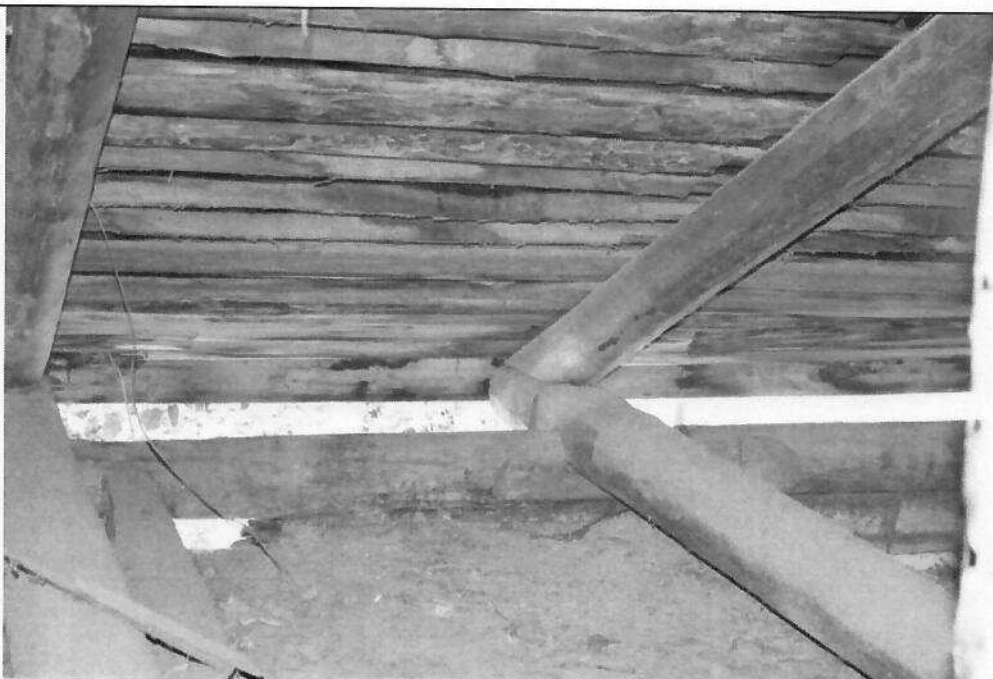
Фрагмент кровли, вид изнутри. Фото 2020 г.
